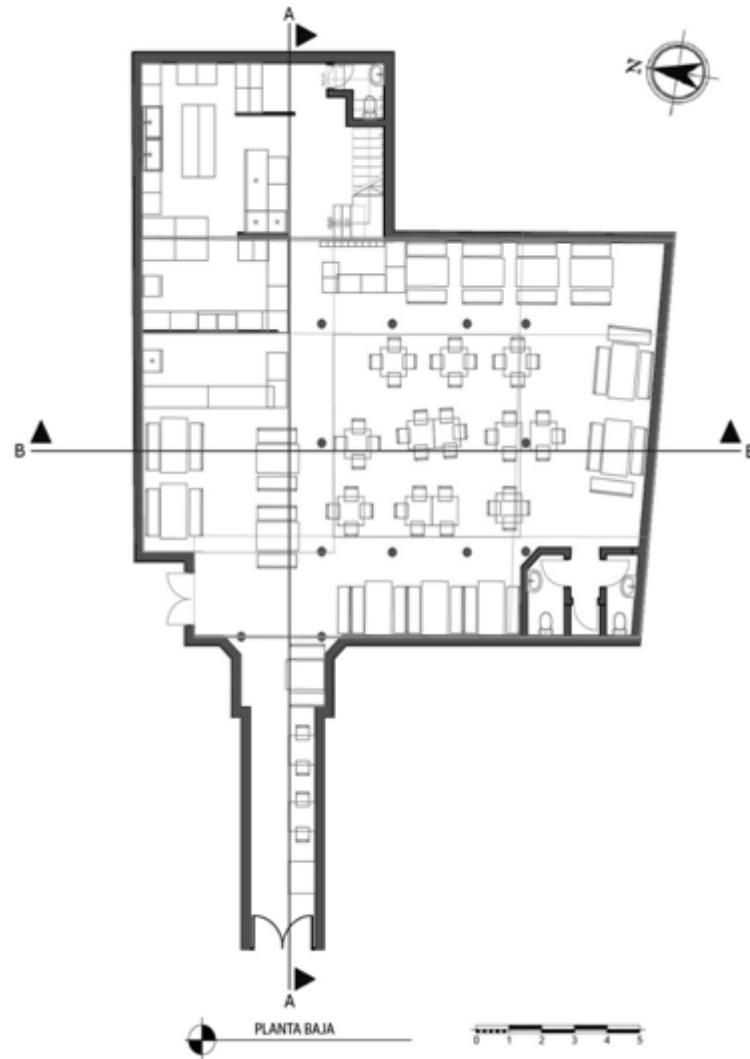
Planimetría del estado actual del restaurante “Los Picantes de Leo” en la ciudad.
